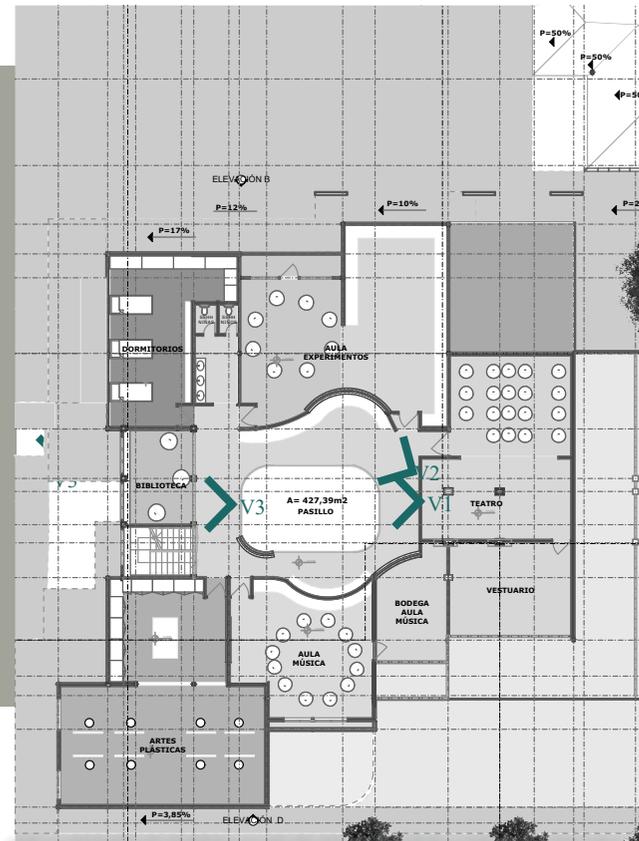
Planta de Vistas en planta alta pasillo lúdico y biblioteca. Fuente: Autora.
